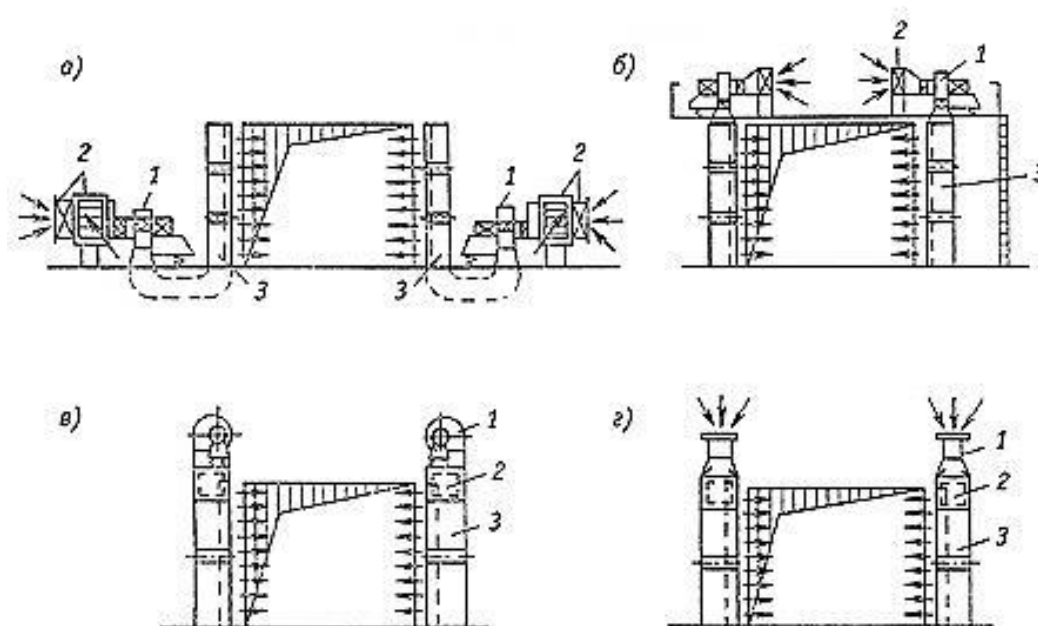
Схема установки агрегатов завес шиберирующего типа:
